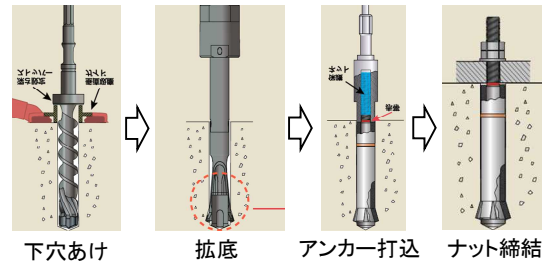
あと施工アンカー（金属拡張式）施工手順⁴⁾
